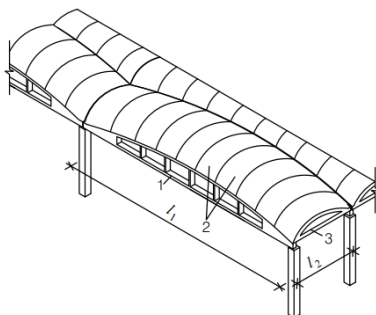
Общий вид сборной длинной цилиндрической оболочки:
